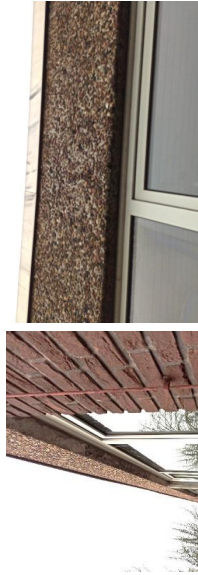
und 22: Fenster ohne Rollläden, Dachkanten mit Waschbeton eingefasst, keine Spalten, Attiken mit Metall eng gearbeitet
